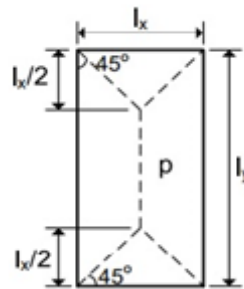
Configuração de ruína de uma laje simplesmente apoiada. (Fonte: Araújo, 2014)
